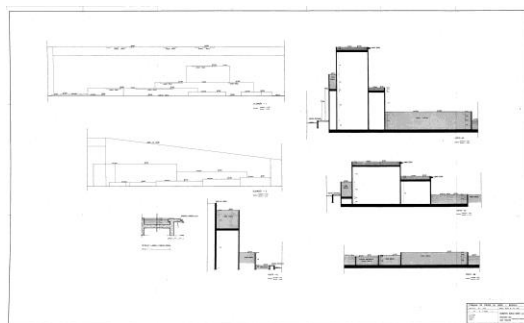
Proyecto original del jardín para el Tribunal de Cuentas de la Unión (proyecto con elevación, detalle y sección).
